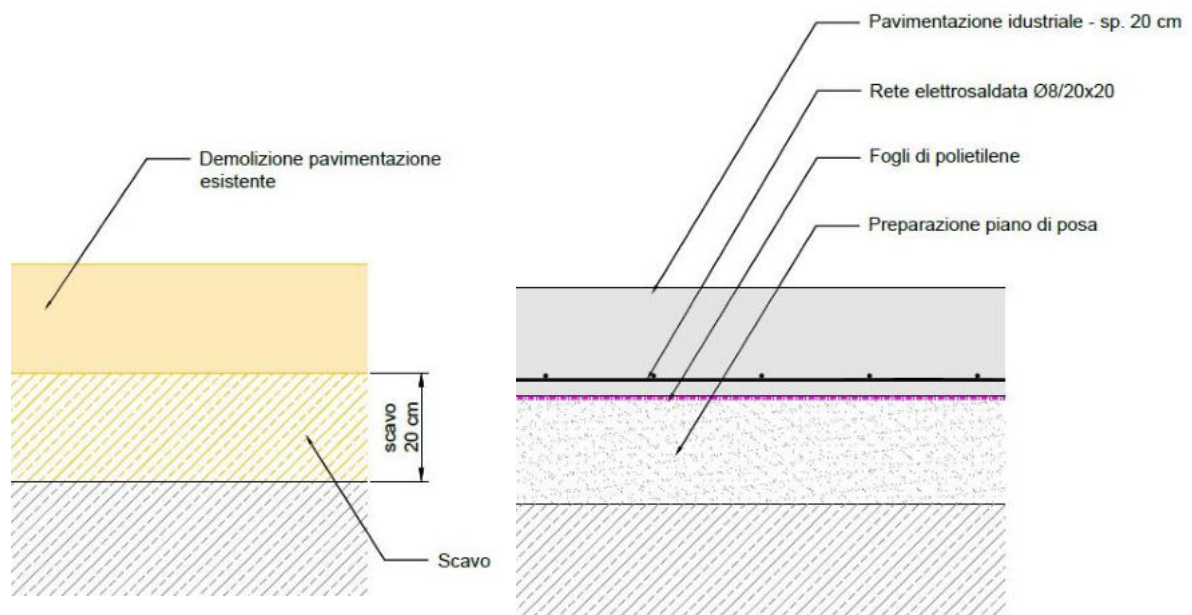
PARTICOLARE TIPOLOGICO "A" - Pavimentazione Industriale
